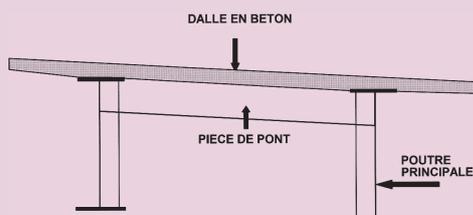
Bipoutre à pièces de pont sans console (cas d'une chaussée monodévers)
